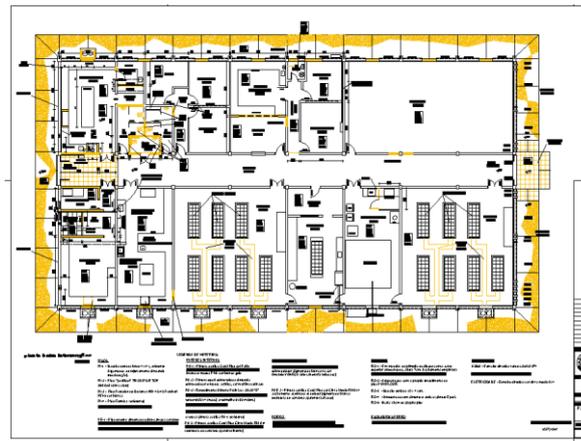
Planta Baixa Prédio 129, em AUTOCAD
